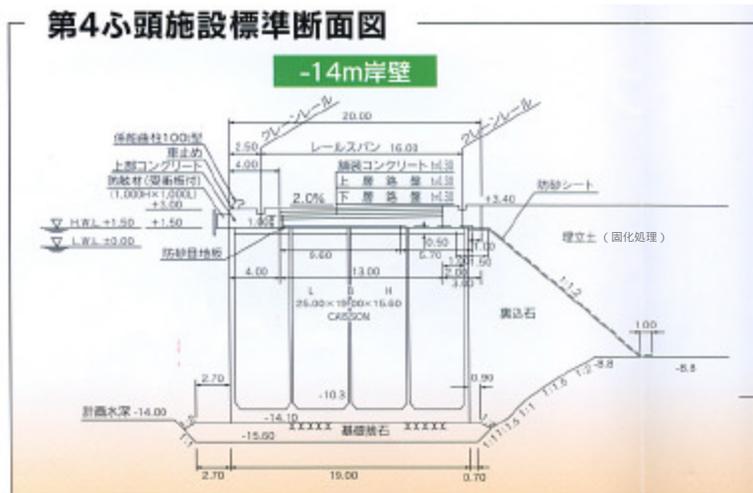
第4埠頭-14m岸壁標準断面図(資料2に加筆)
